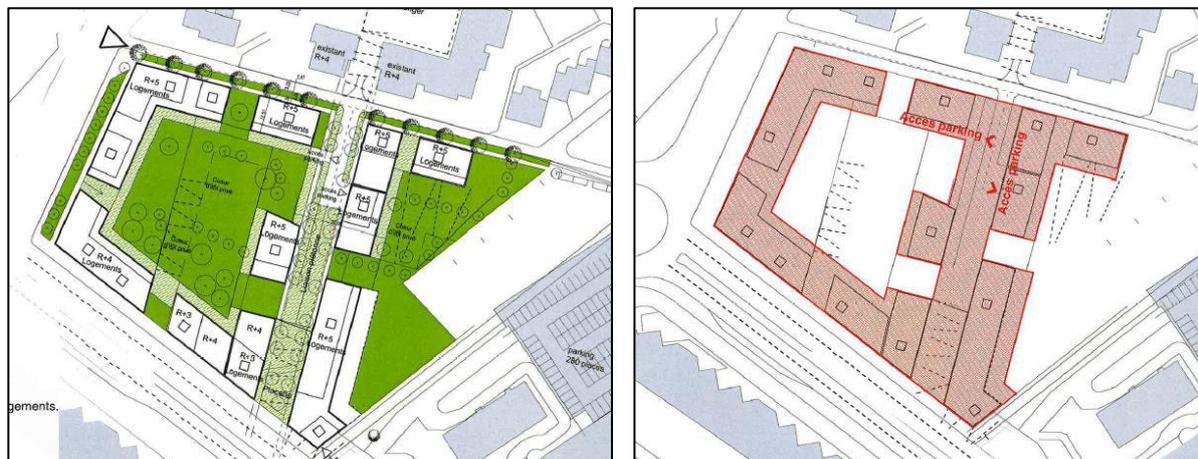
Plan du RDC et du sous-sol du projet d'aménagement (source : Kaufman & Broad)
